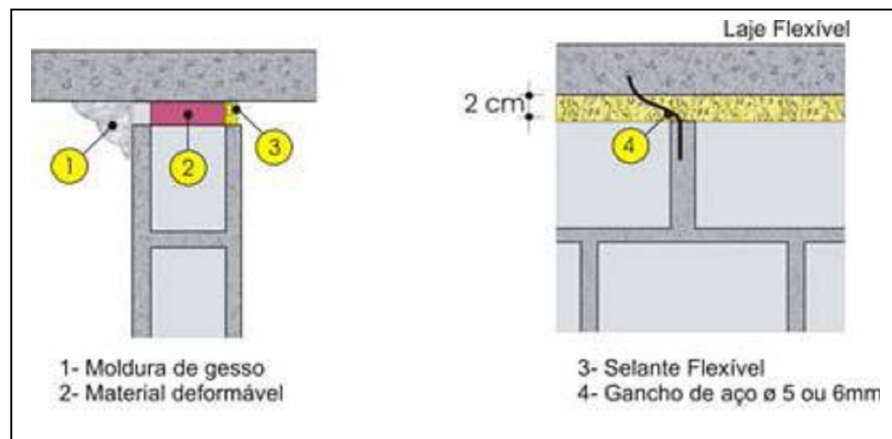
Detalhes de ligação das alvenarias com viga ou laje muito deformável. [38]
